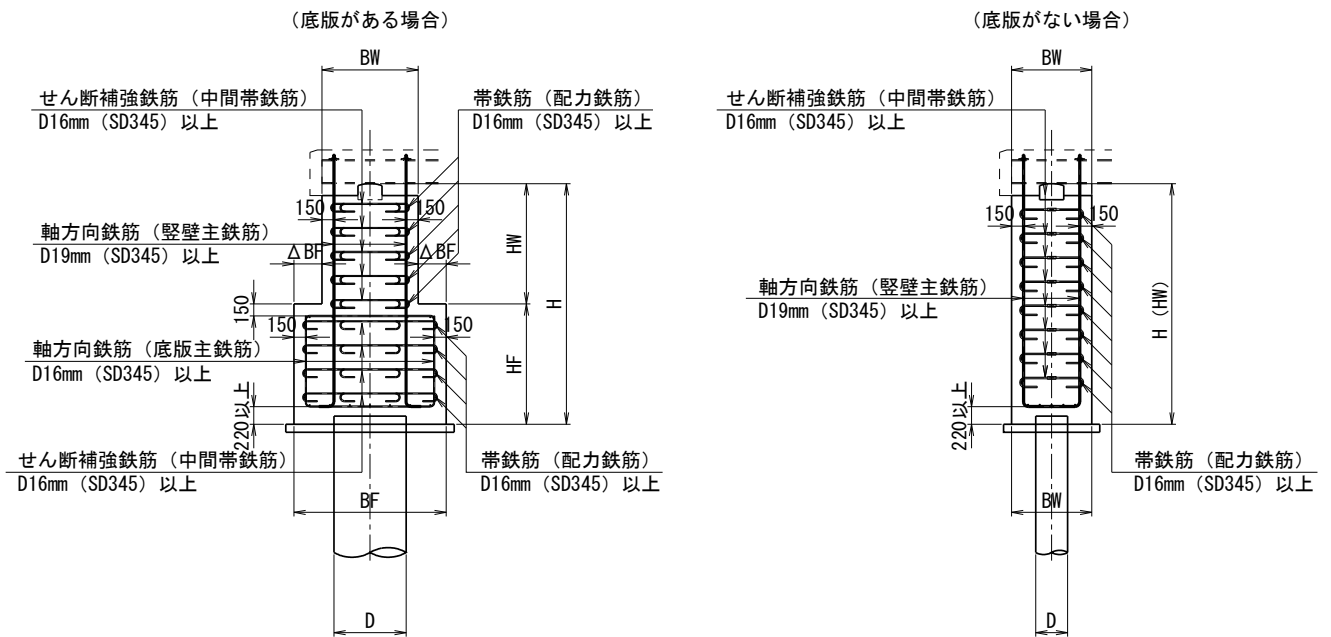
下部構造の鉄筋および配置（単列杭基礎）
